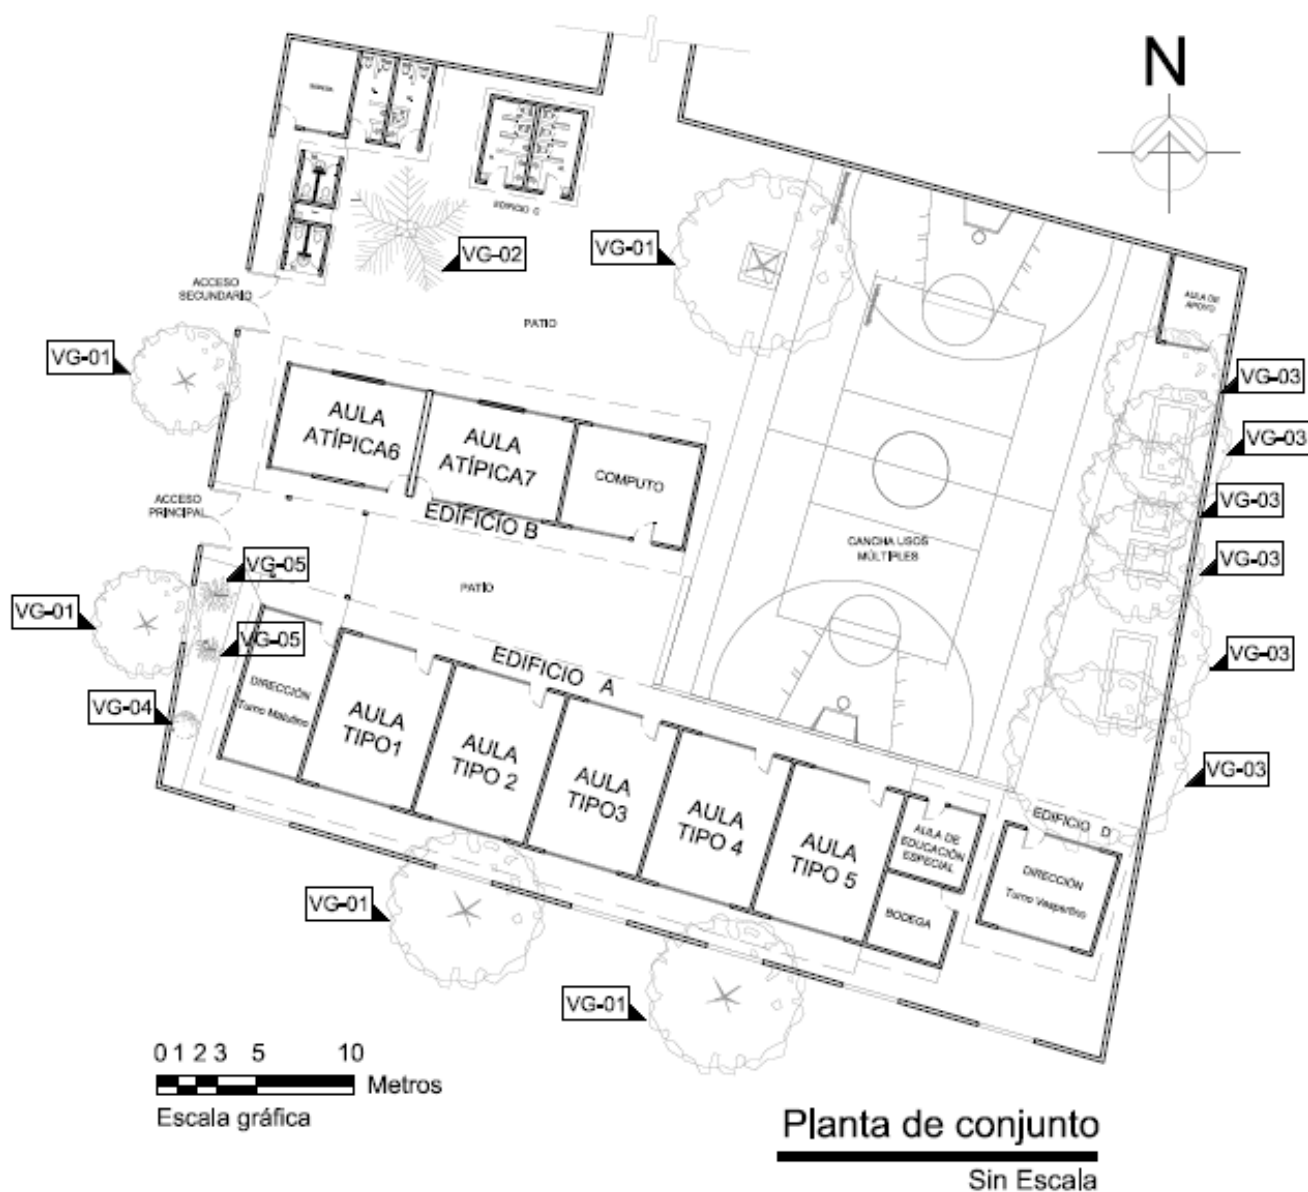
VEGETACIÓN-Planta arquitectónica de conjunto.
